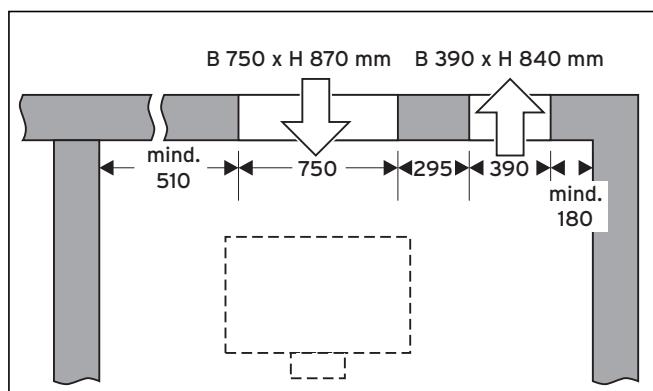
Wand-Installation, Luftaustritt rechts
